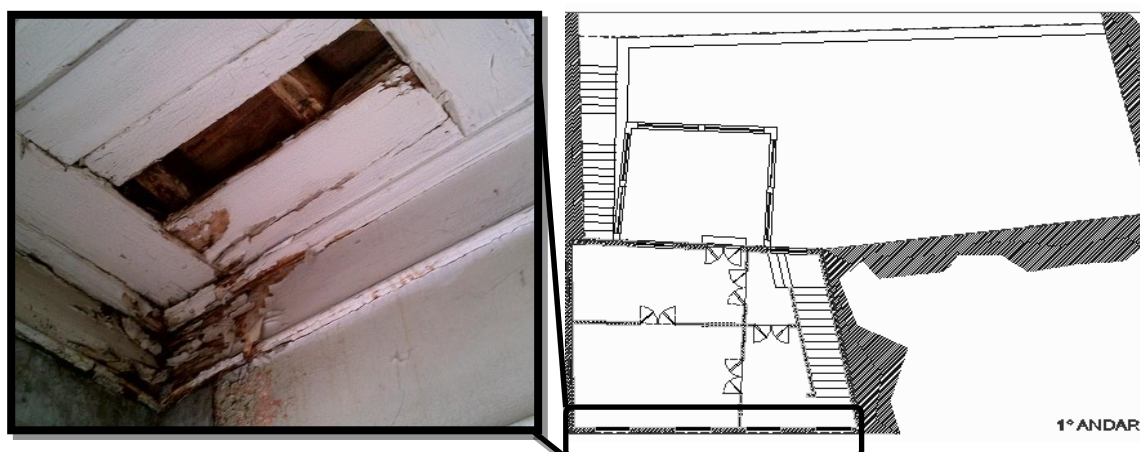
Anomalia 16 - Fotografia e localização em planta
